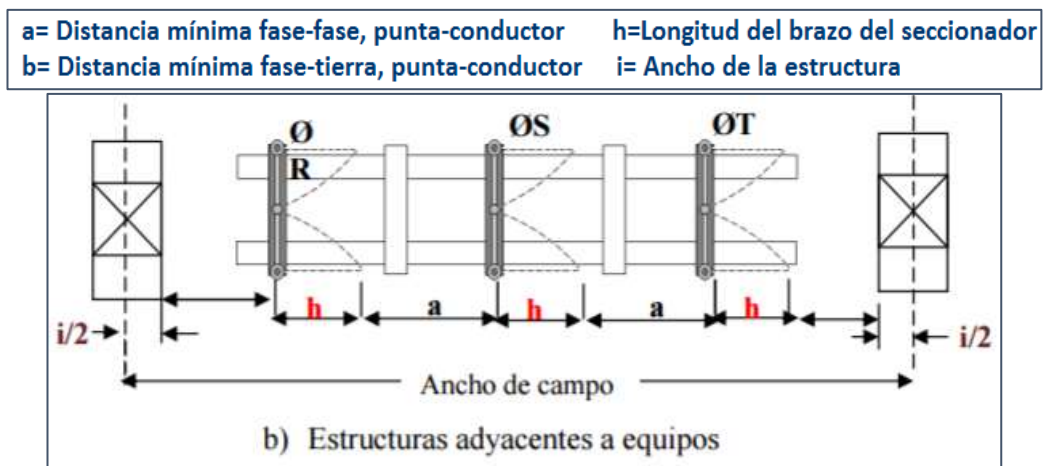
Distancia entre ejes de pórtico y seccionador
